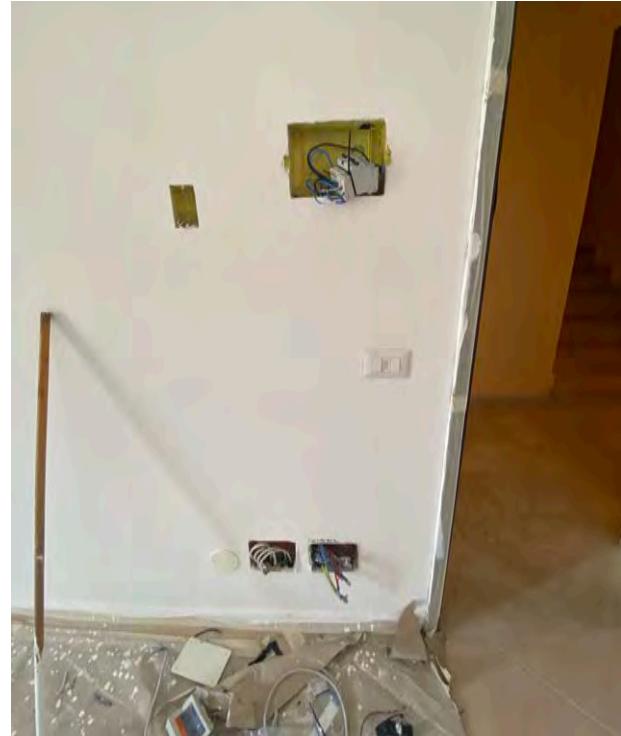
PARTICOLARE DGLI IMPIANTI PRESENTI MA NON ULTIMATI
